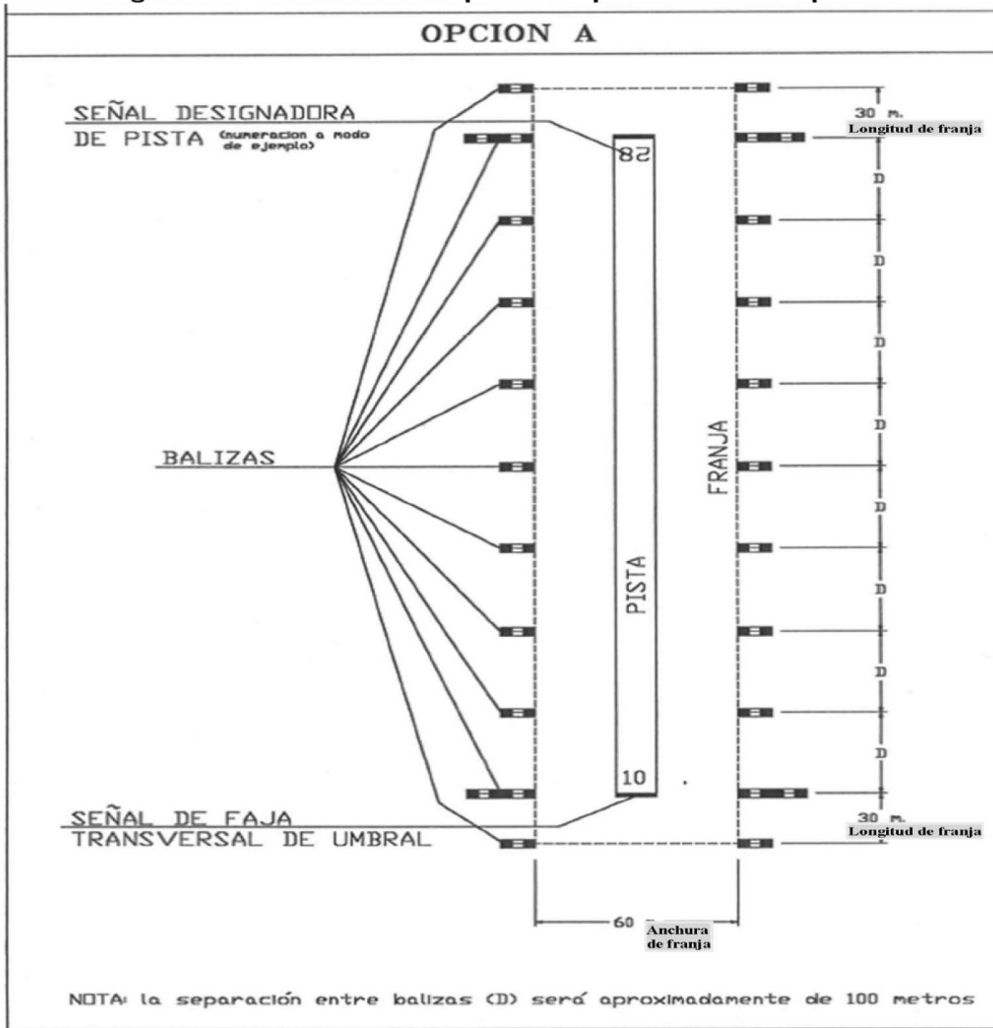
Señalización de pistas no pavimentadas con umbral desplazado
